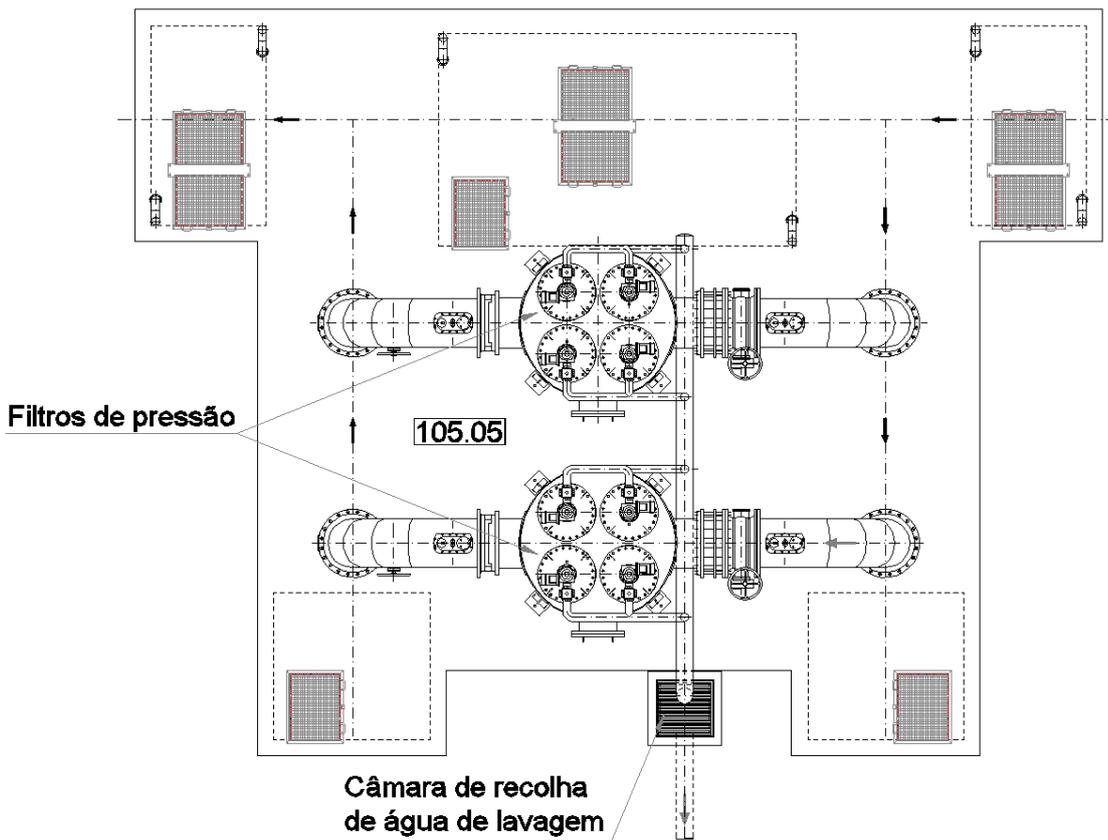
Planta da estação de filtração de Vale do Gaio
